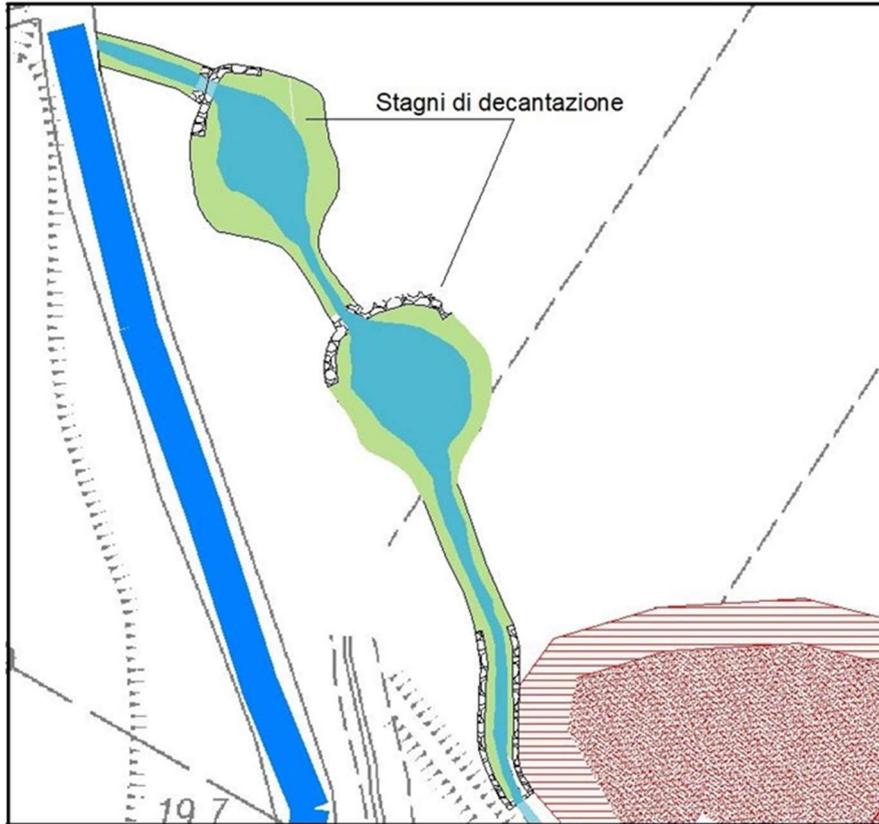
Rinaturalizzazione del tratto finale dello scolo AUSA Nuova: schema in pianta con individuazione delle zone da rivestire in massi di pietra arenaria cementati.
